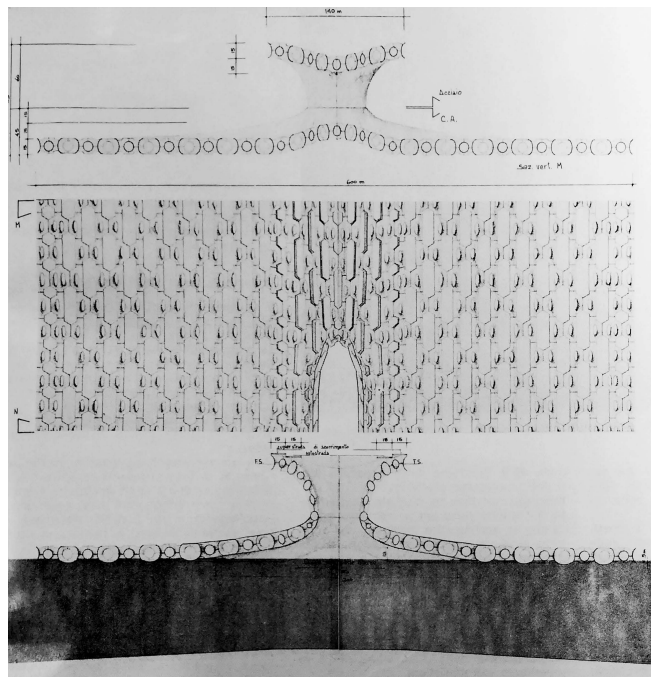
R. Semino, pianta e sezione trasversale della piastra galleggiante sullo Stretto di Messina, 1969 (per gentile concessione dell'arch. Rinaldo Semino).
